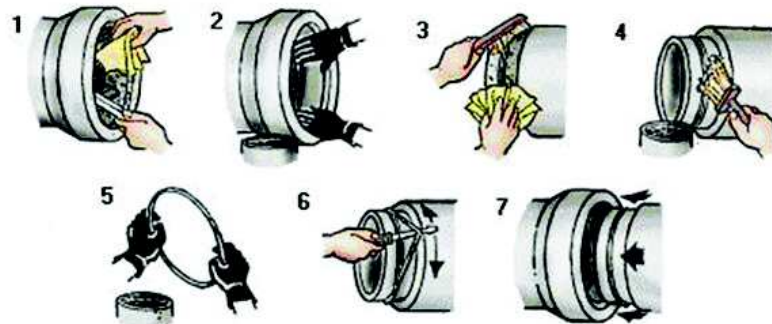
Forma correcta instalación de tuberías de hormigón.
